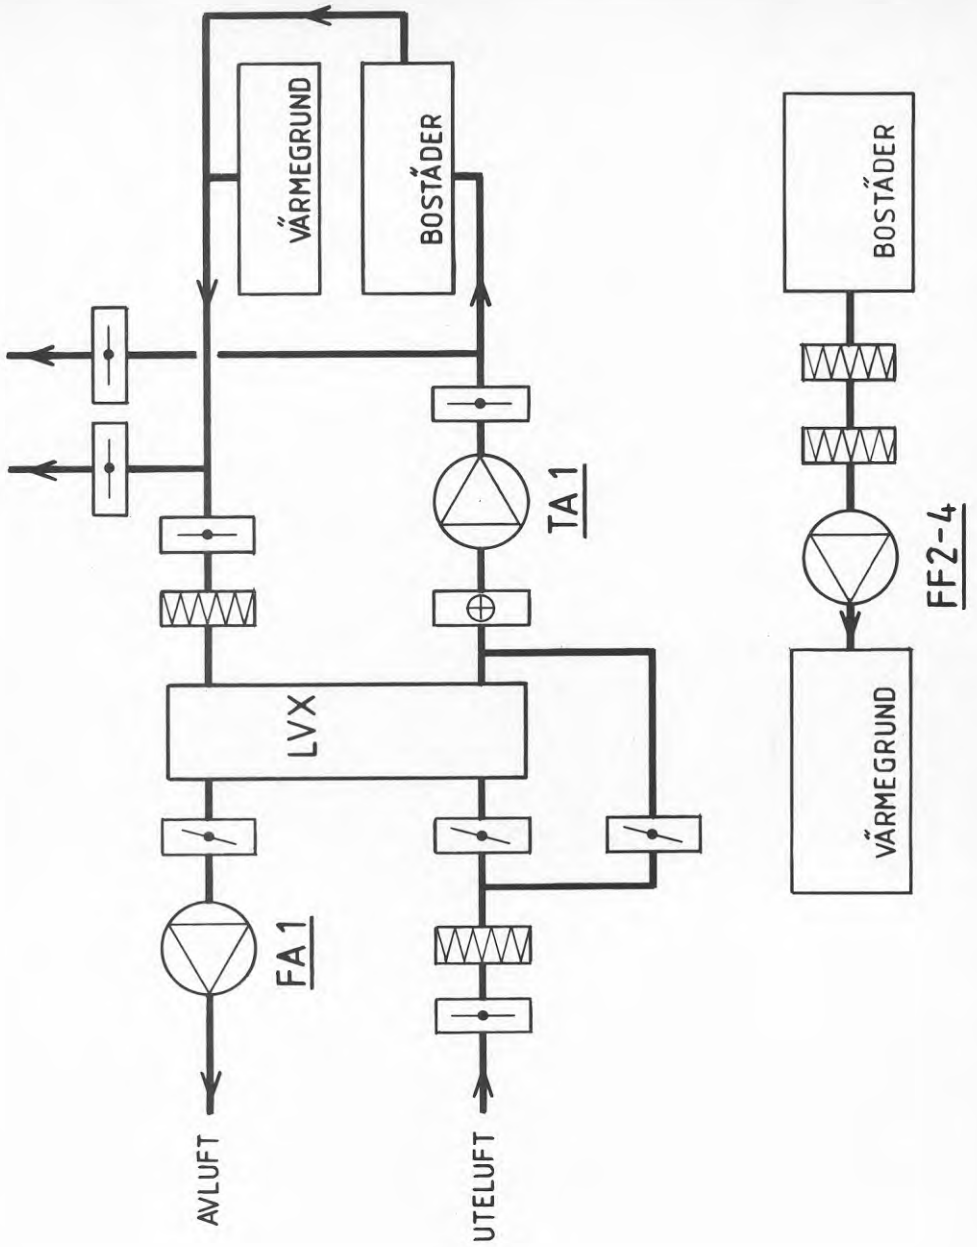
Funktionsschema för ventilation alternativ med värmegrund
